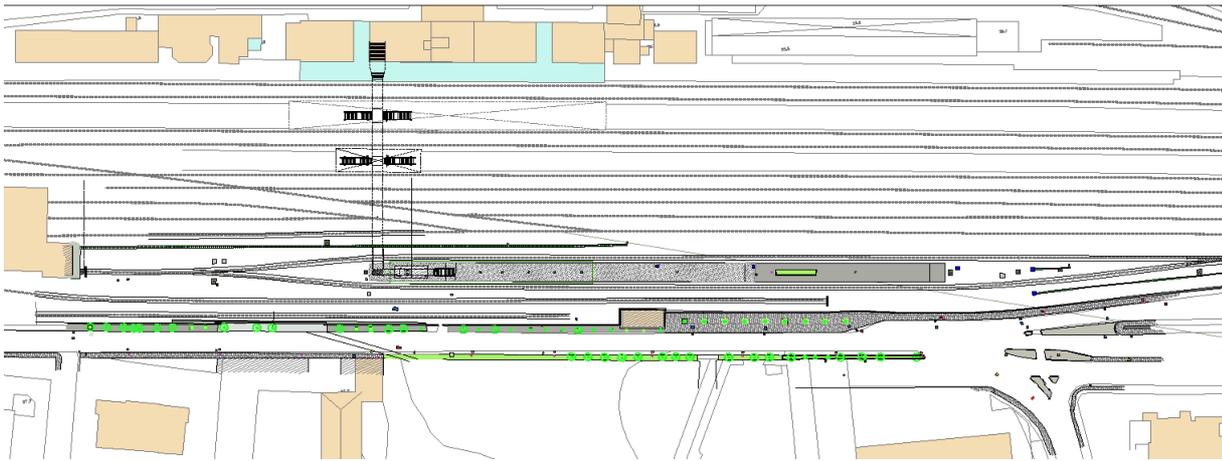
Stazione di Barletta Centrale: stato dei luoghi
